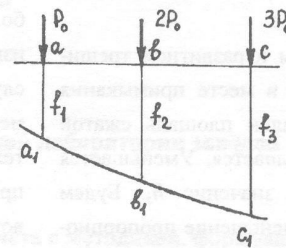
К расчету силы и прогиба железобетонного свободноопертого элемента
